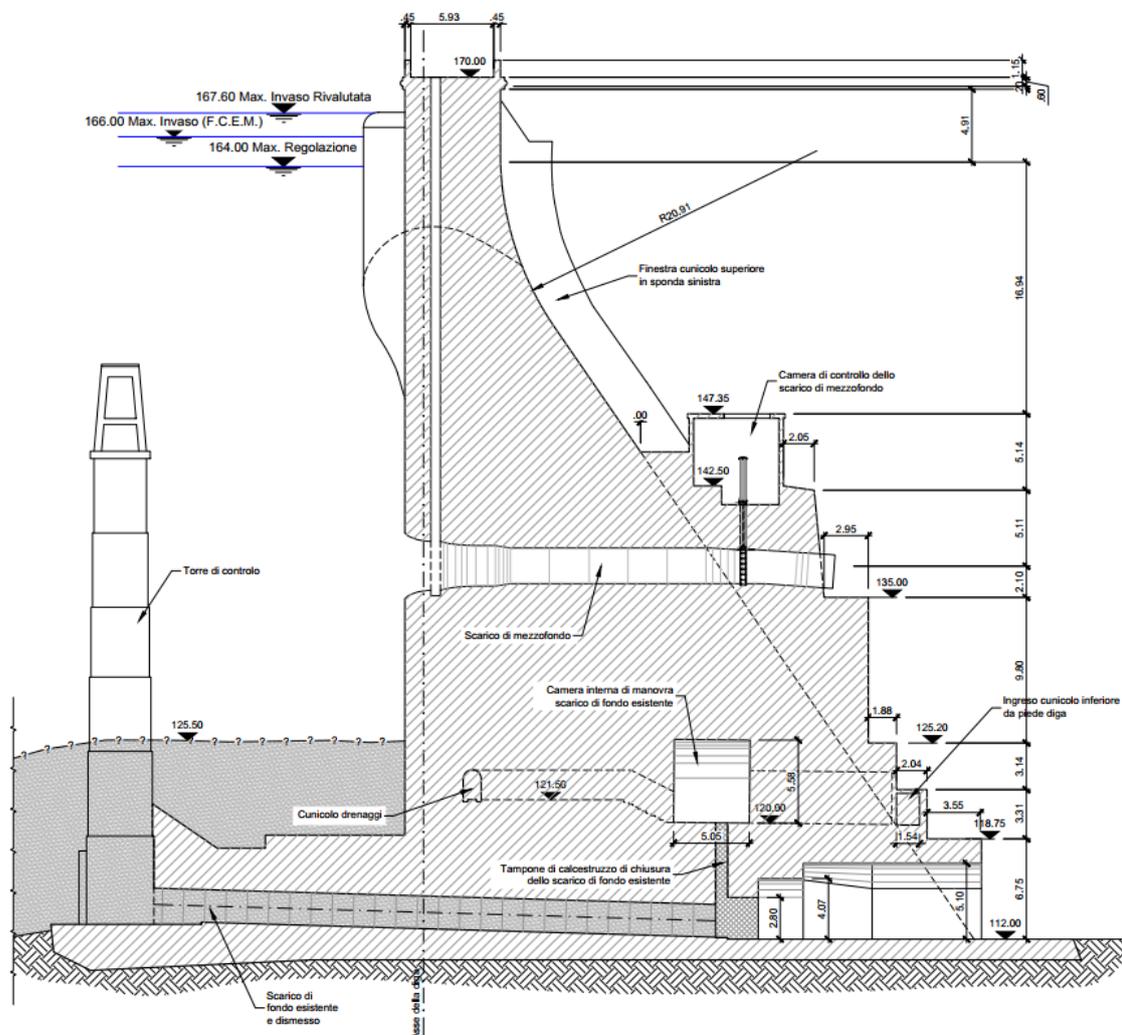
Diga di Muzzone – Stato di fatto: sezione del concio oggetto di intervento.
